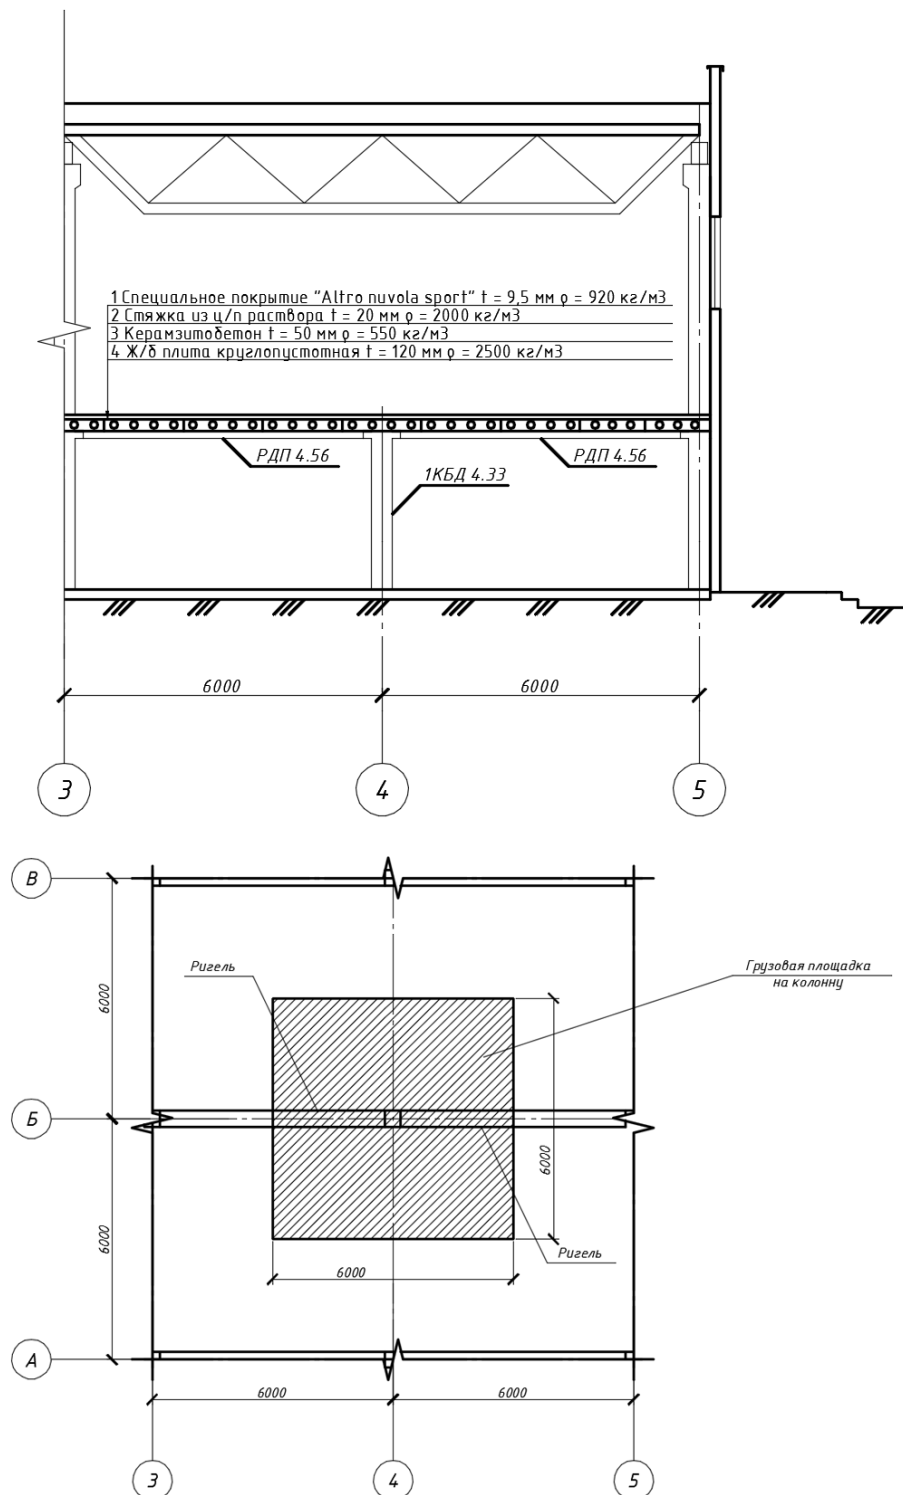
Сбор нагрузок на колонну среднего ряда
